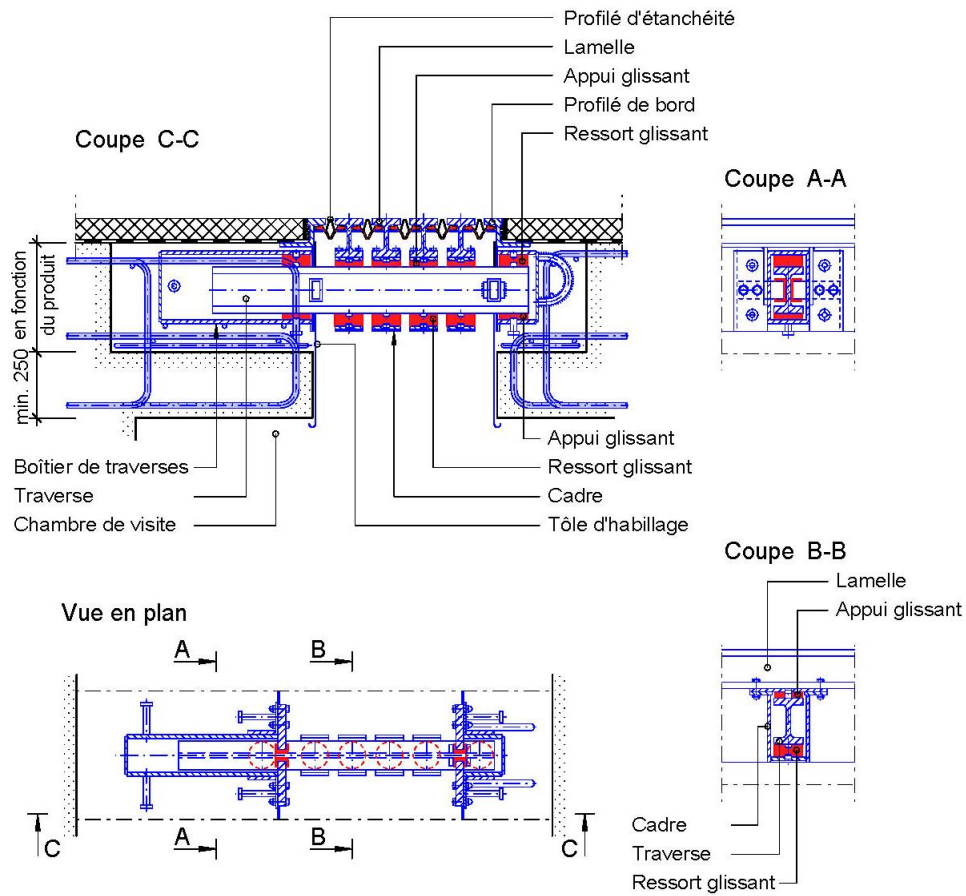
Vue d'en dessus et coupe schématiques d'un joint de chaussée à plusieurs profilés compressibles.
